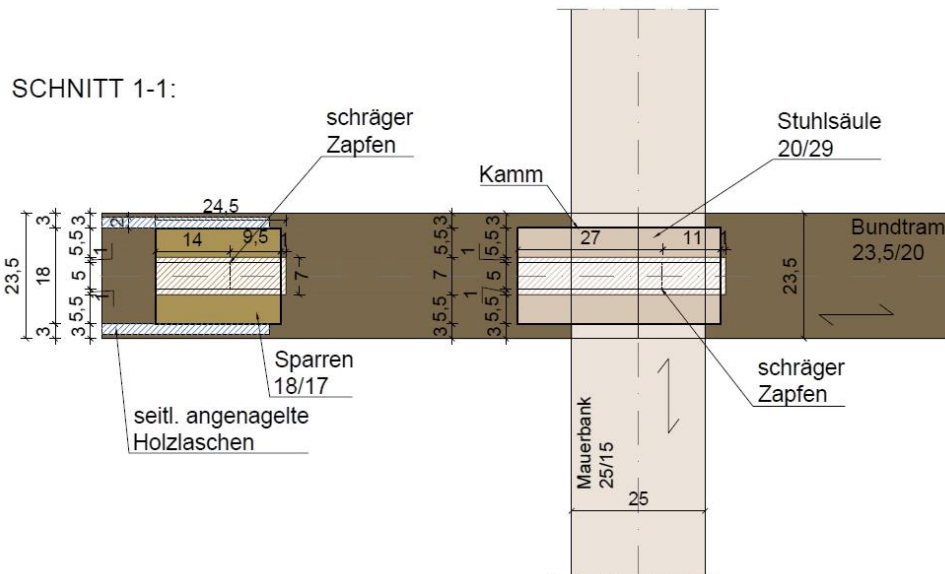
D02 Fußpunkt Vollgespärre Grundriss
